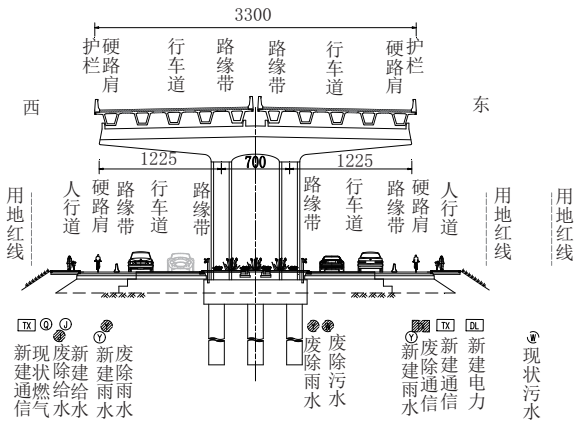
利群路-福泰路管线综合标准横断面布置图(单位:mm)
